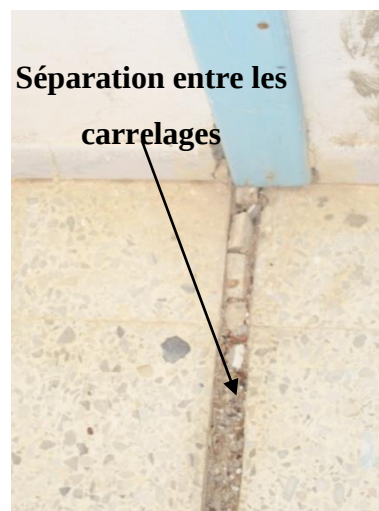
Vue de l'ouverture du joint de rupture n°1 au niveau de premier étage
